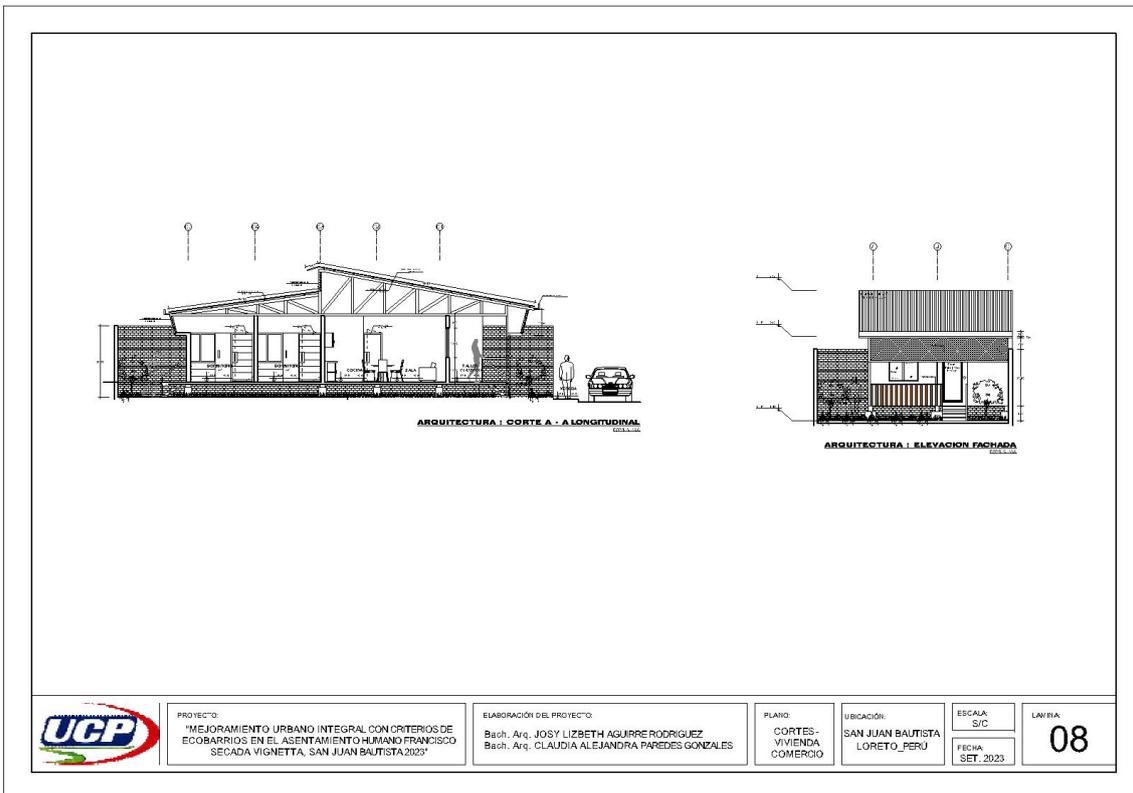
Vivienda Comercio – Cortes y Elevación
